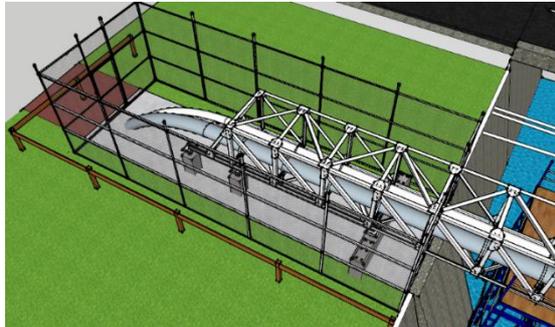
Lantai Kerja Beton Setebal 120 mm
